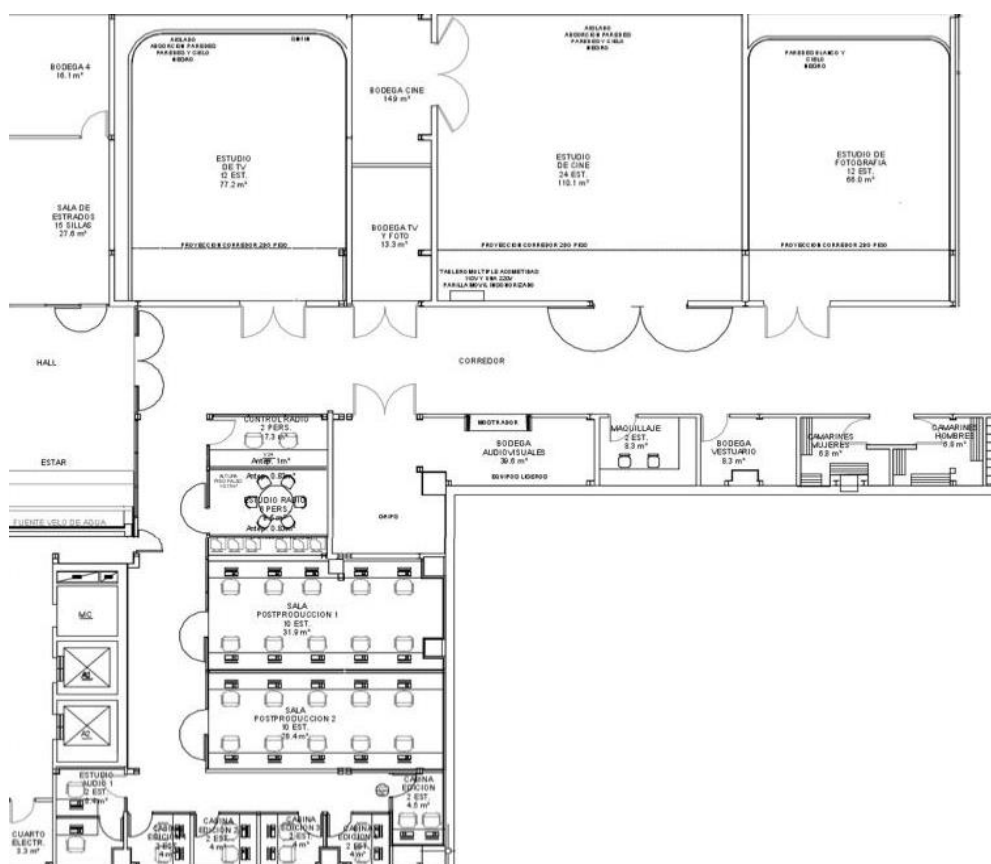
Subsuelo 5. Ubicación del Estudio de Televisión. Planta Baja
